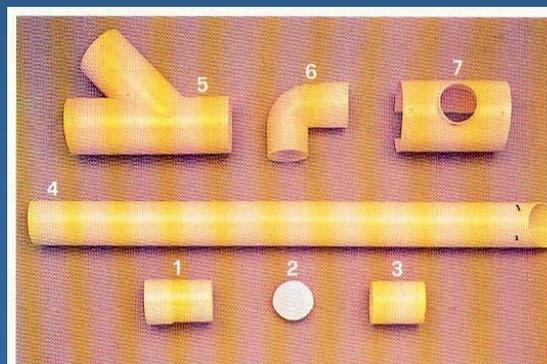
Accessori e raccorderia delle tubazioni drenanti.
